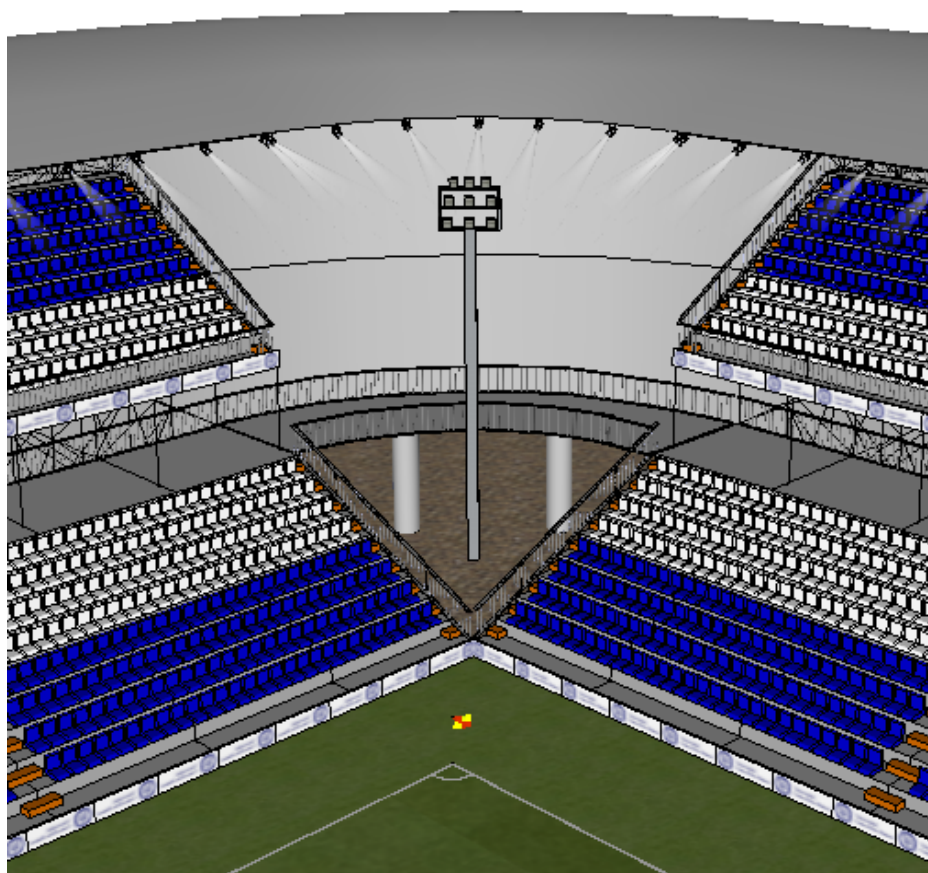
Ensamblaje estructura para los córners en vista isométrica
